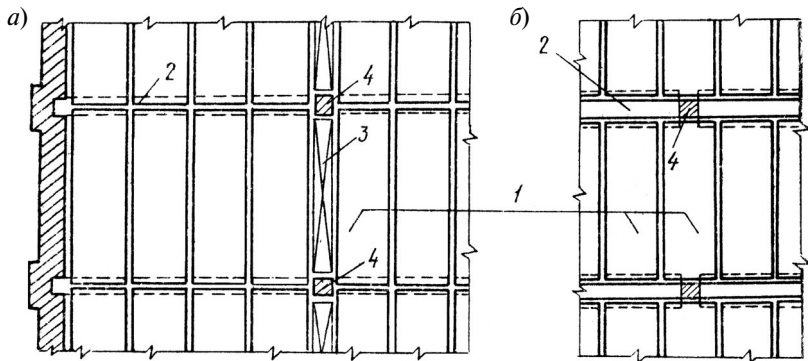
Расположение сборных панелей на перекрытии при различных схемах опирания их на прогоны: а — опирание сверху; б — опирание на консольные выступы
